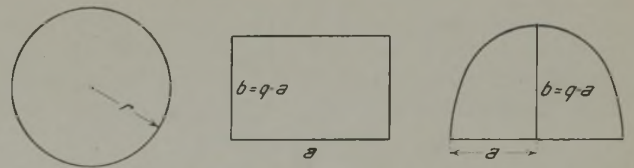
Die wichtigsten Streckenquerschnittsformen.
